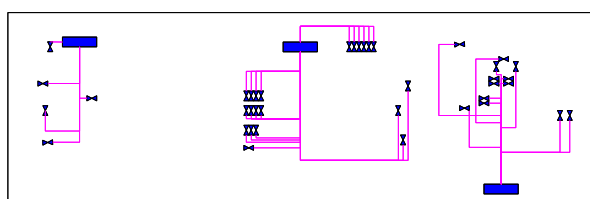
representación detallada de la planta baja – Terminales de válvulas (no se muestran los conductos neumáticos).
